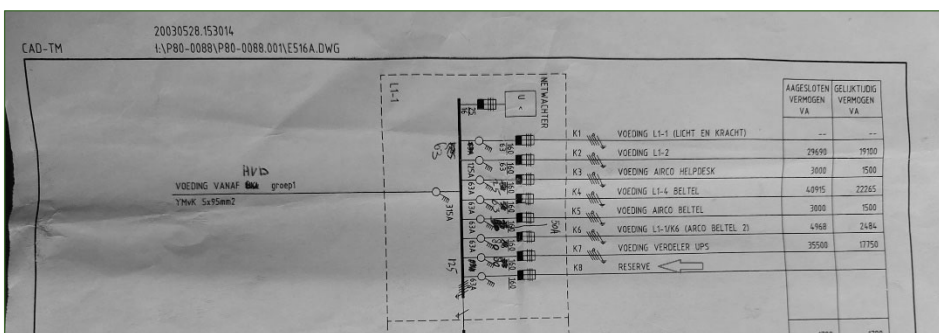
Installatieschema verdeelinrichting L1-1, detail.
